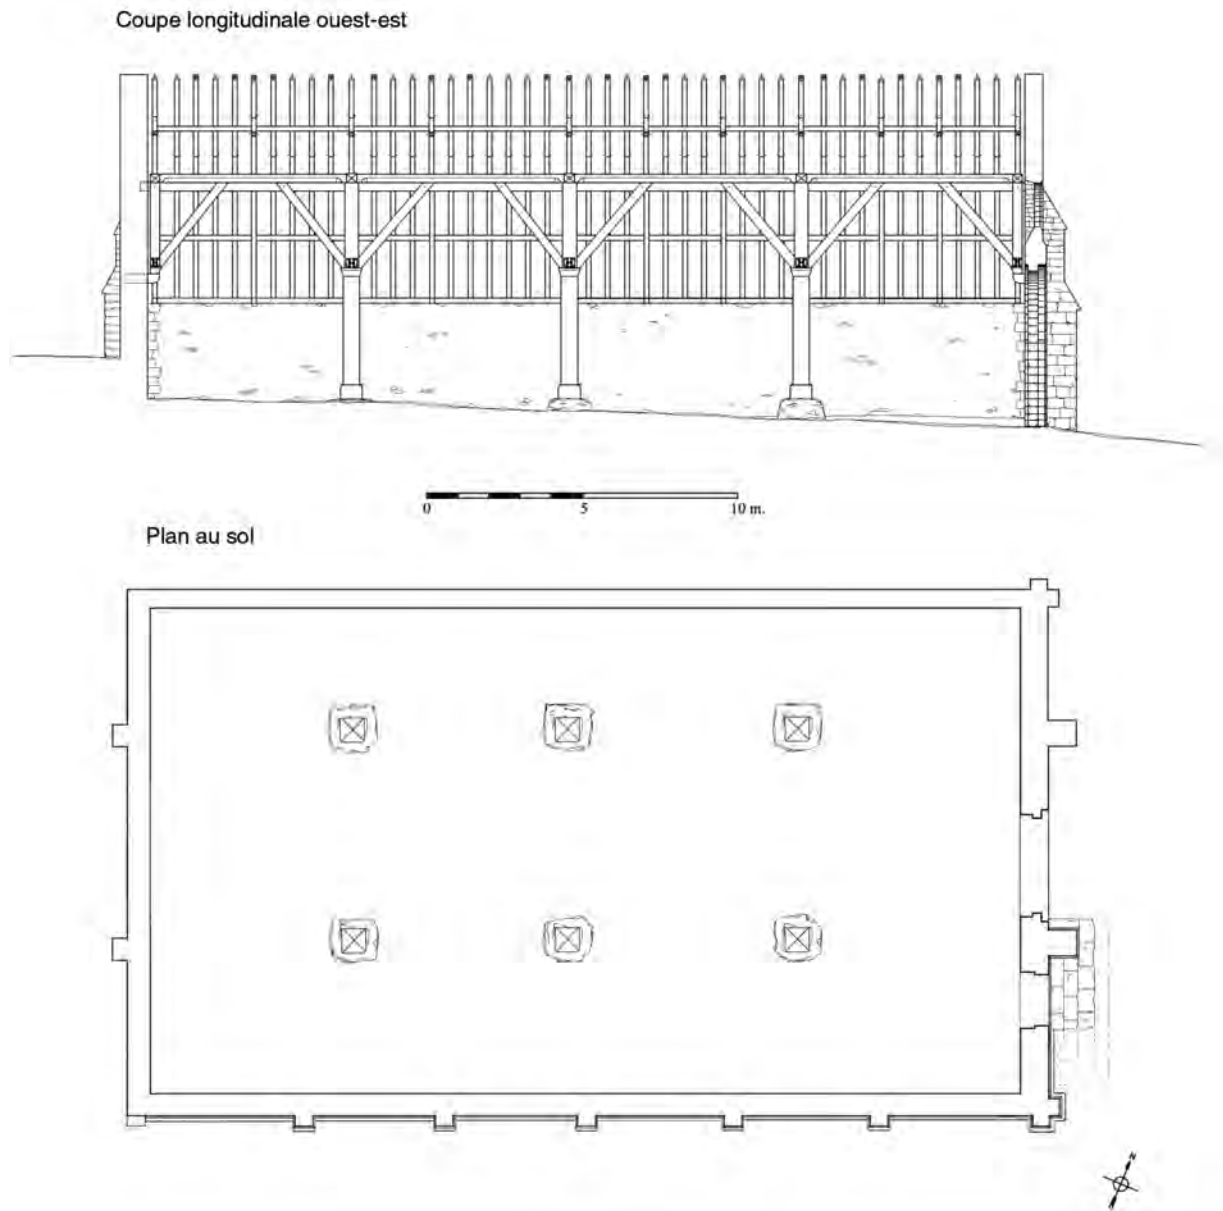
Coupe longitudinale ouest-est et plan au sol de la grange (1216-1220d).
